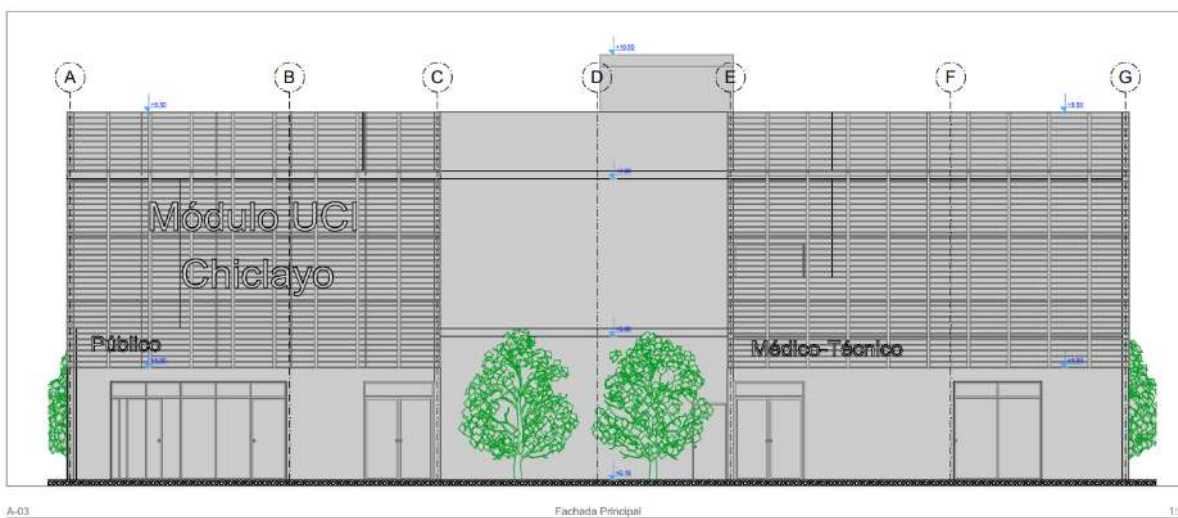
Elevación de Fachada Principal – Arquitectura
